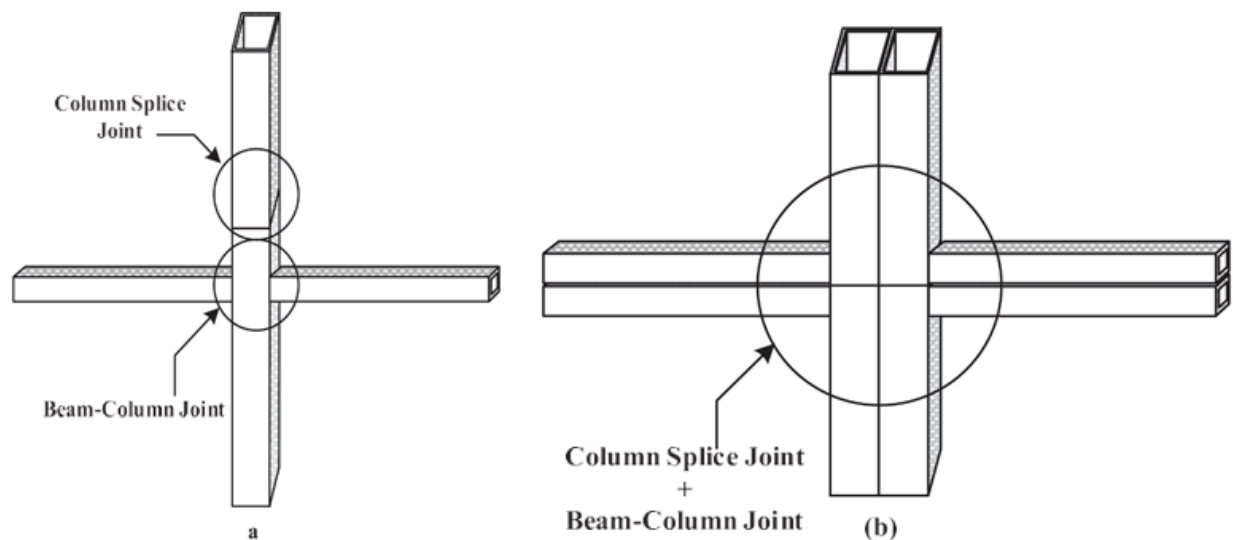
Esquema de a) conexión tradicional para estructuras metálicas b) conexión rígida intermodular
